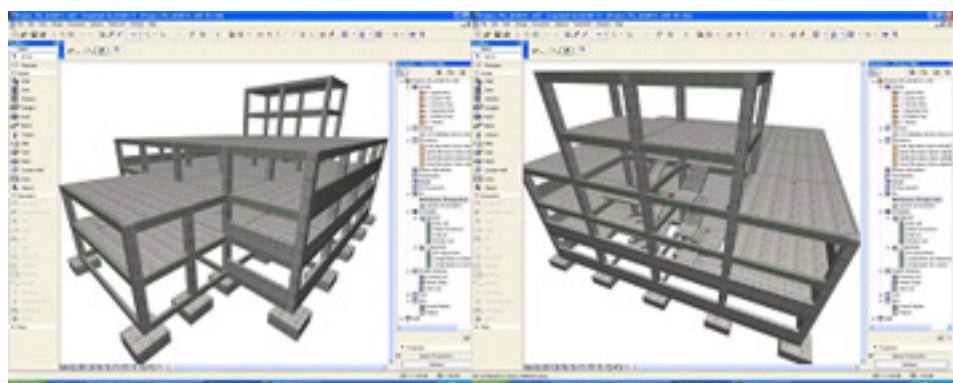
Revit Architecture 2011 – Modelo estrutural de concreto armado
